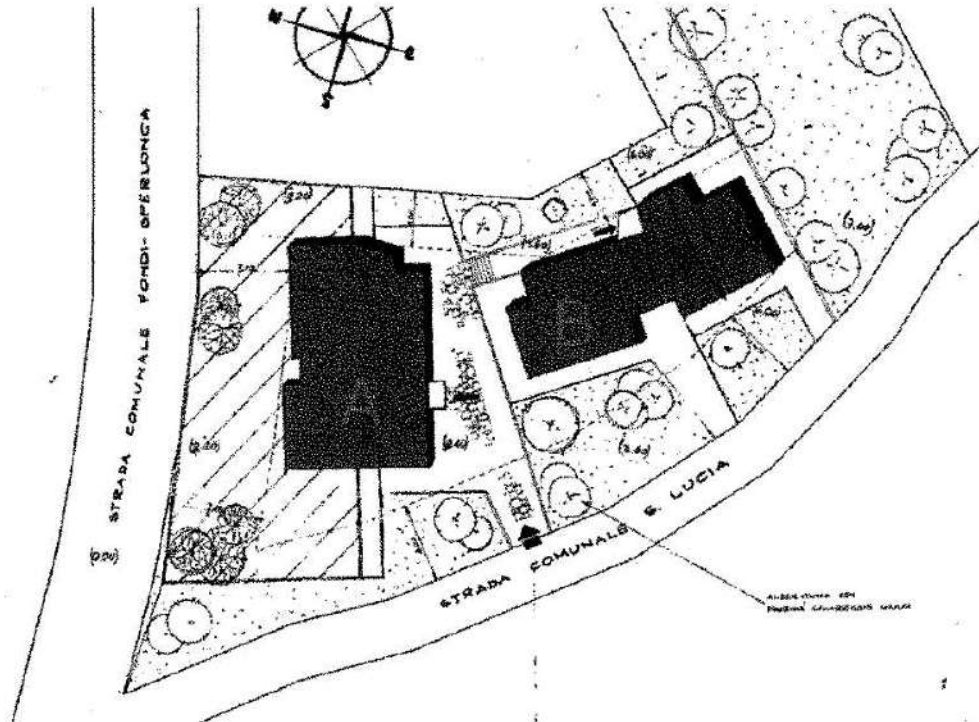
Progetto approvato dalla Commissione edilizia del 29/12/1961
